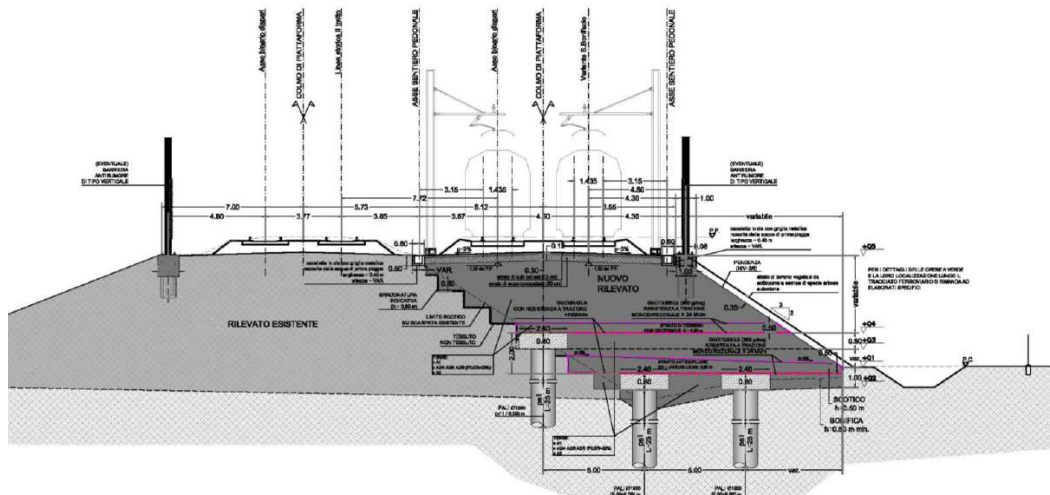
Progetto Definitivo - sezione "TIPO C" di intervento con rilevato in affiancamento alla linea storica
